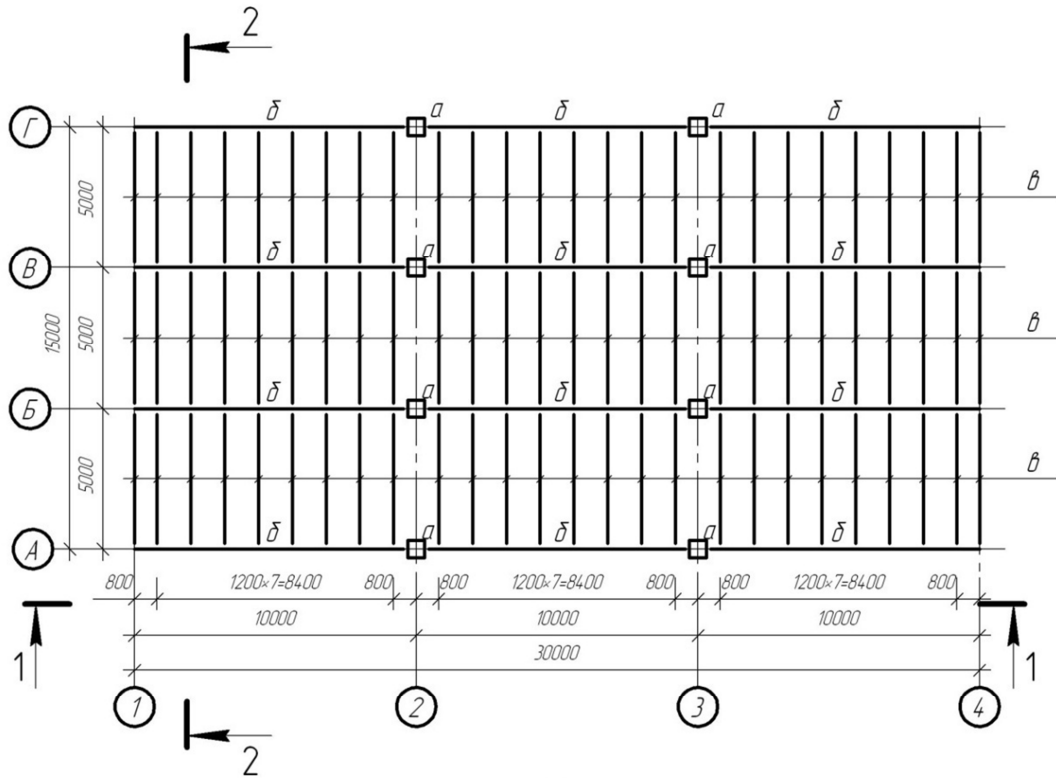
Компоновка балочной клетки: а – колонны; б – главные балки; в – второстепенные балки
